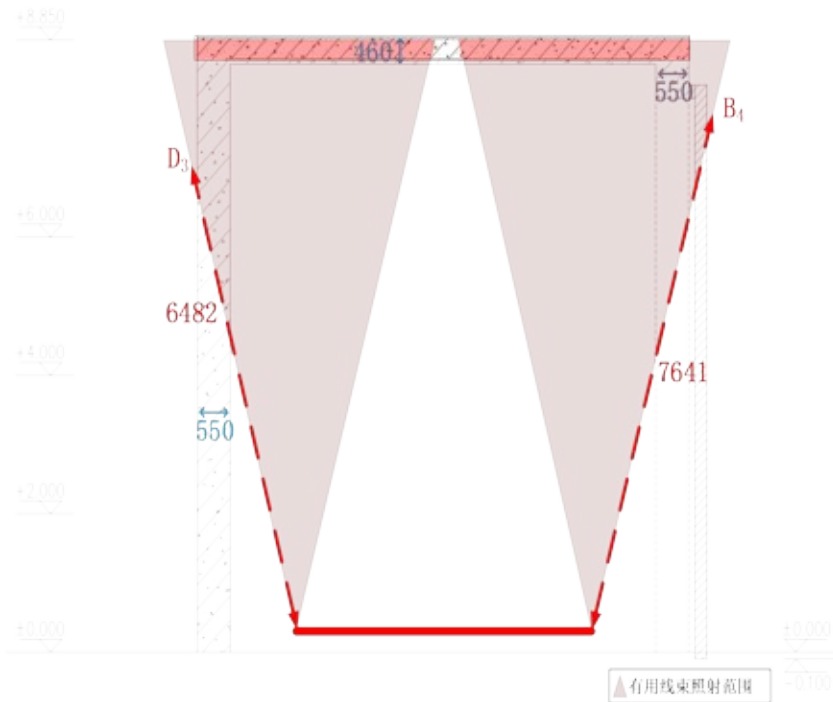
周向探伤机关注点位示意图（剖面图 2，单位：mm）
